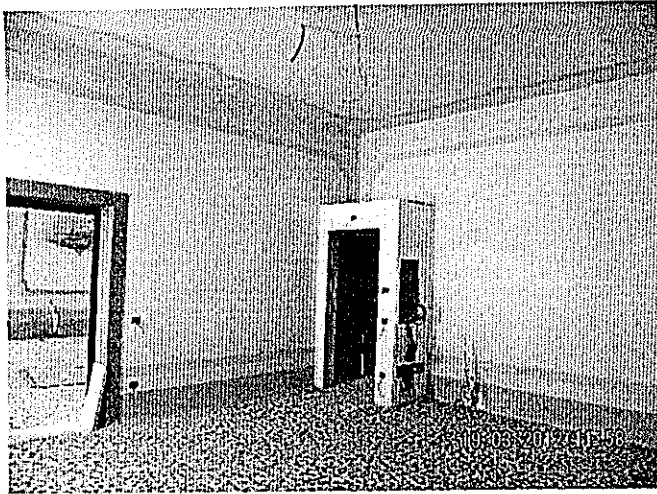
Stanza 1.8- Parete lato interno e porta sala
